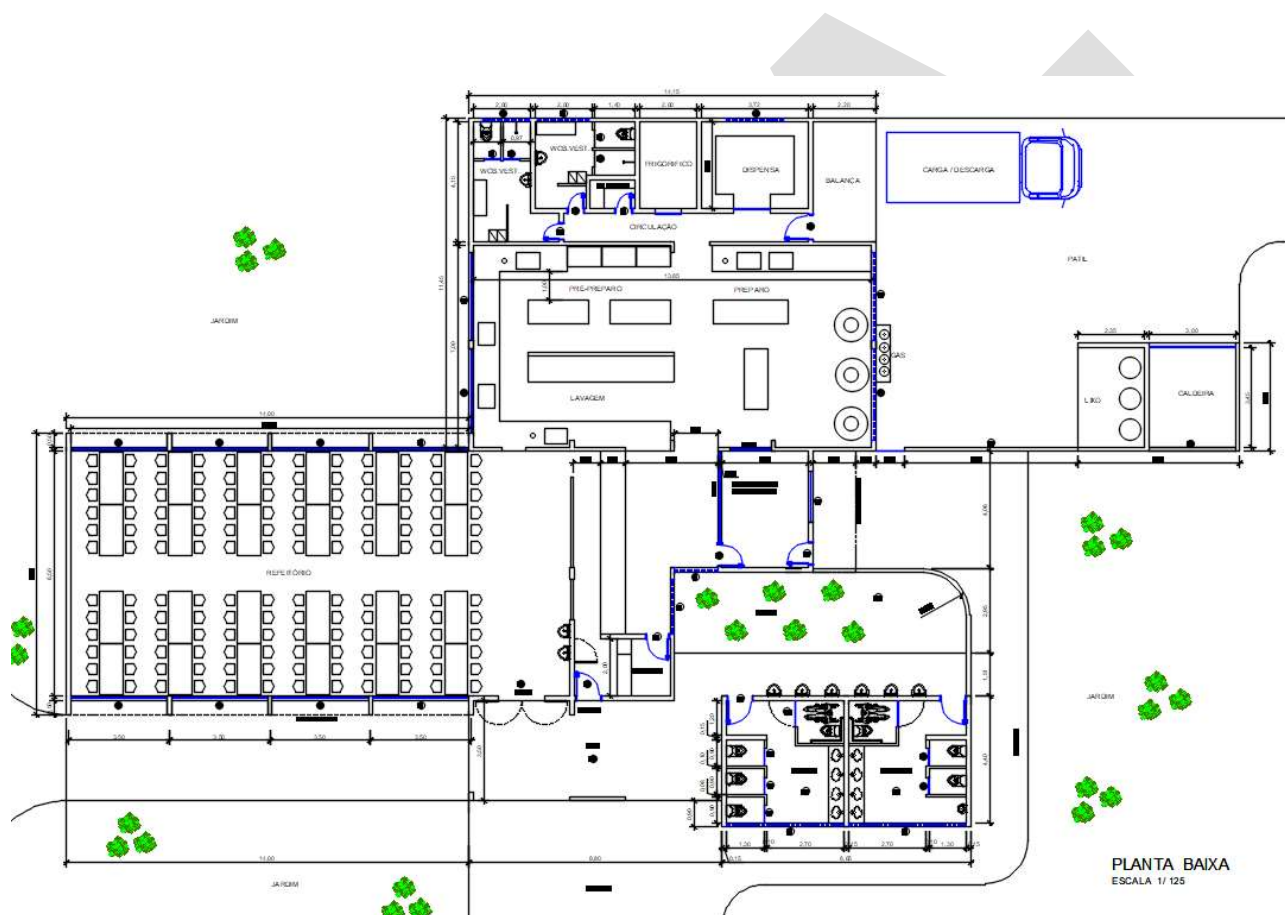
Planta Baixa da Edificação. Fonte: PU/UFCG
